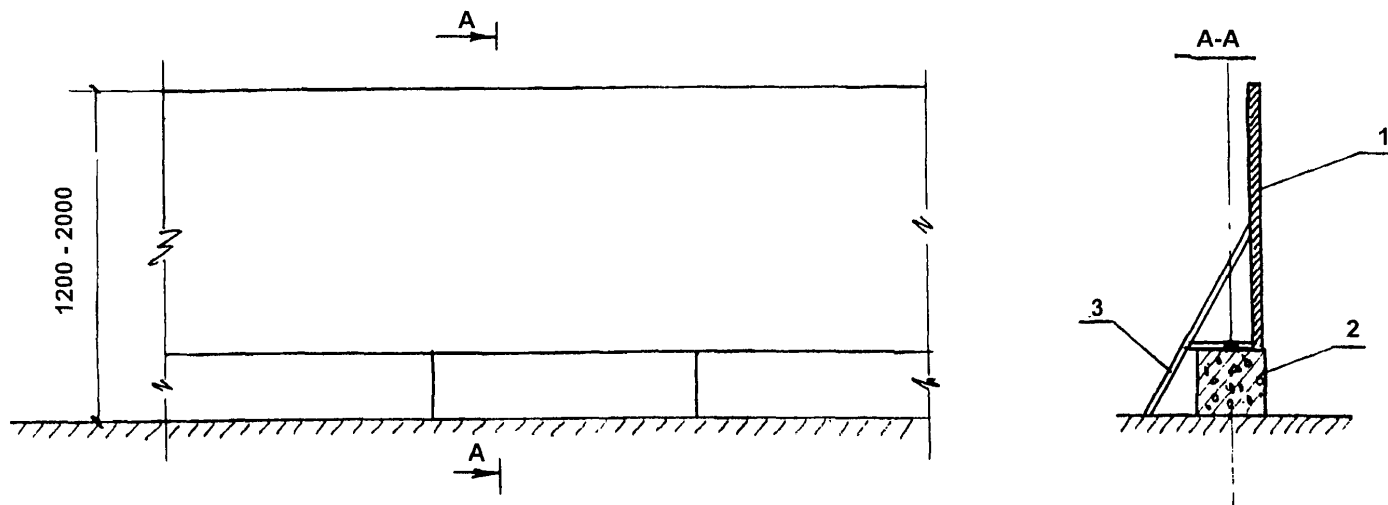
Ограждение мест производства работ с применением сборных железобетонных фундаментных блоков:
